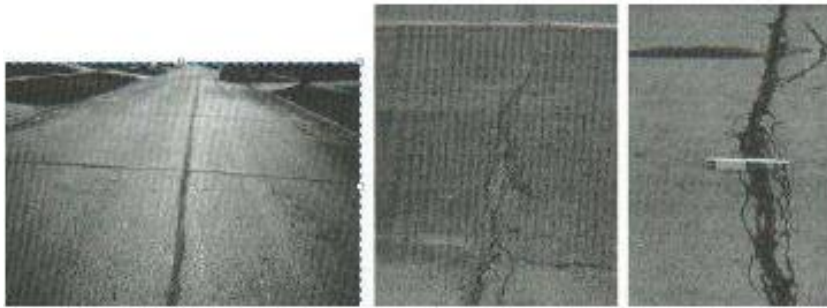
Falla por grieta de reflexión de junta de baja, media y alta severidad, de izquierda a derecha
